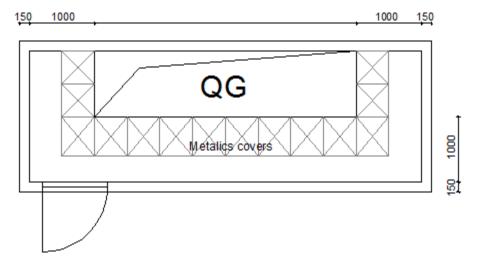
Dimensões mínimas para instalação de um quadro geral para instalações colectivas com ligação de acesso frontal.
